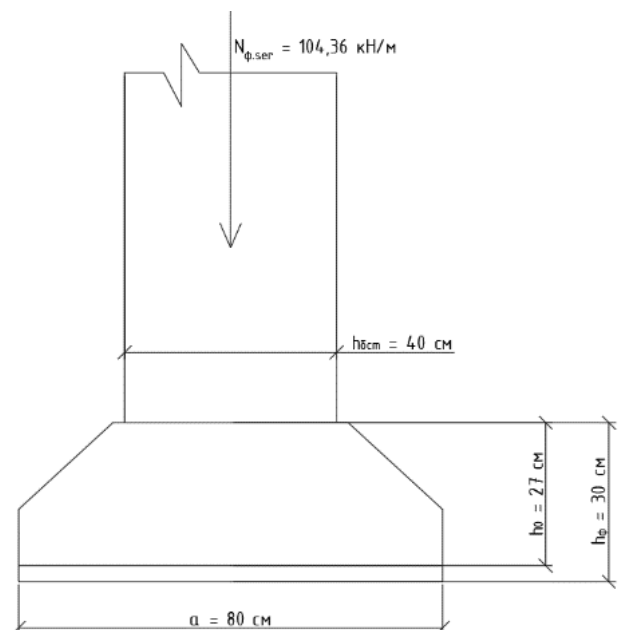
Розрахункова схема стрічкового фундаменту
